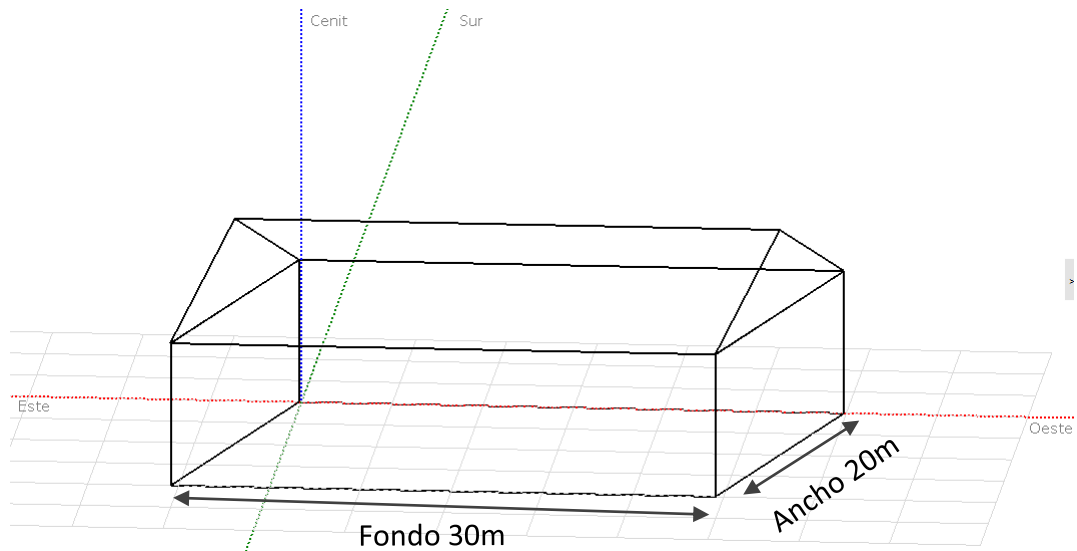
Dimensionamiento planta. Nave industrial
